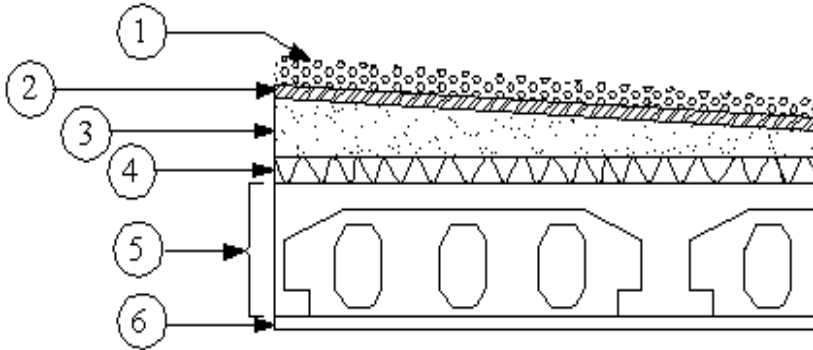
coupe transversale d'un plancher terrasse inaccessible
